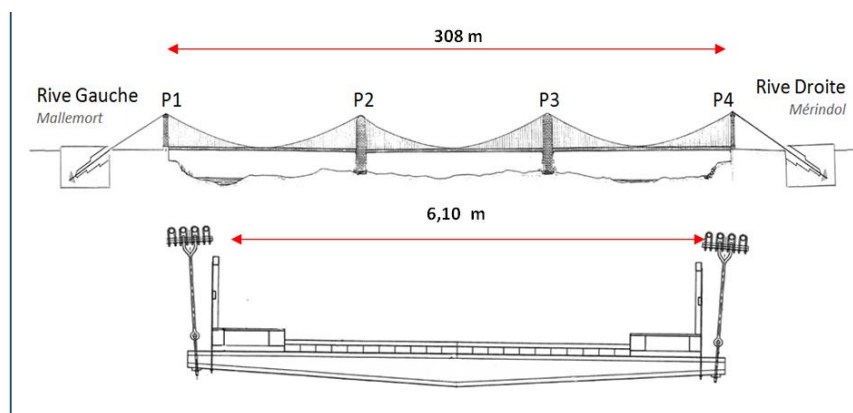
Vue en plan du pont suspendu de Mallemort (Source : CD13)
